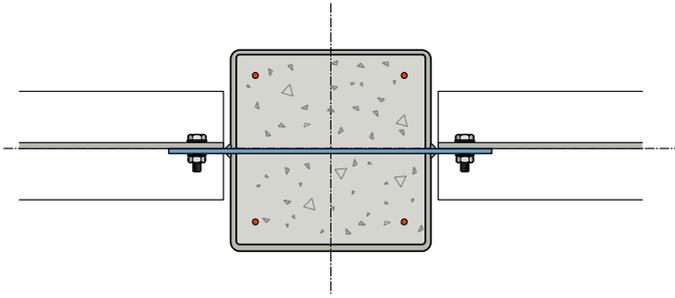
Assemblage bilatéral articulé par plat traversant sur poteau mixte à section creuse carrée
